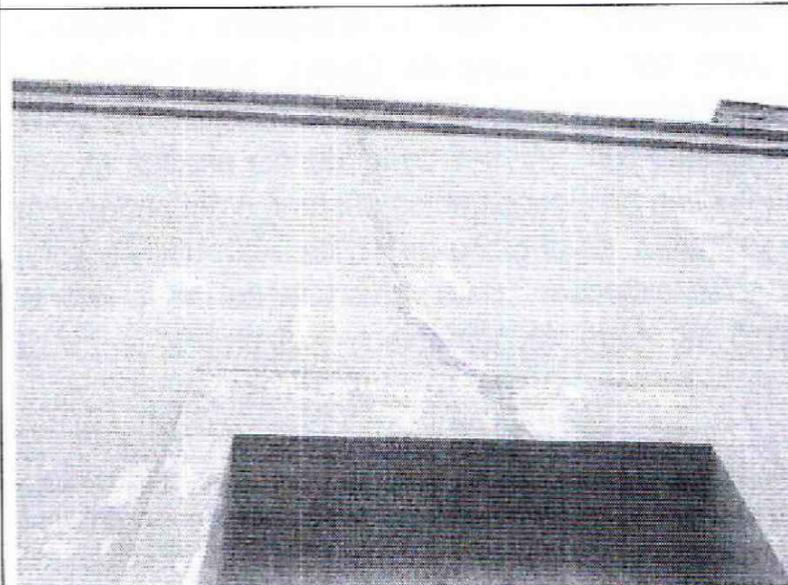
Grieta vertical en punto medio de parte embebida.
